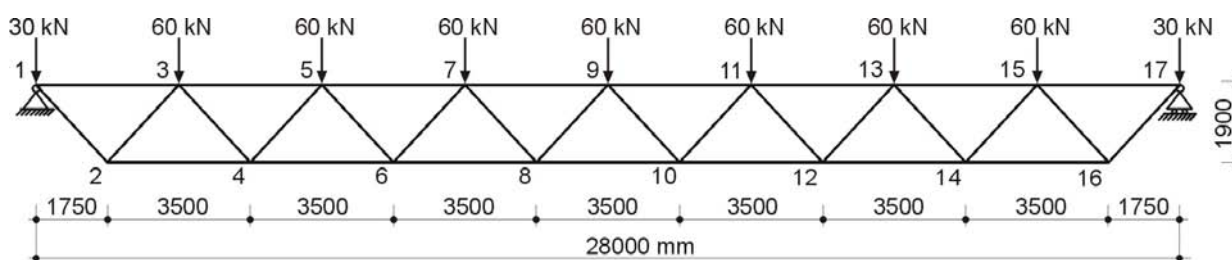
Treliça uniplanar submetida a um carregamento de amplitude constante
